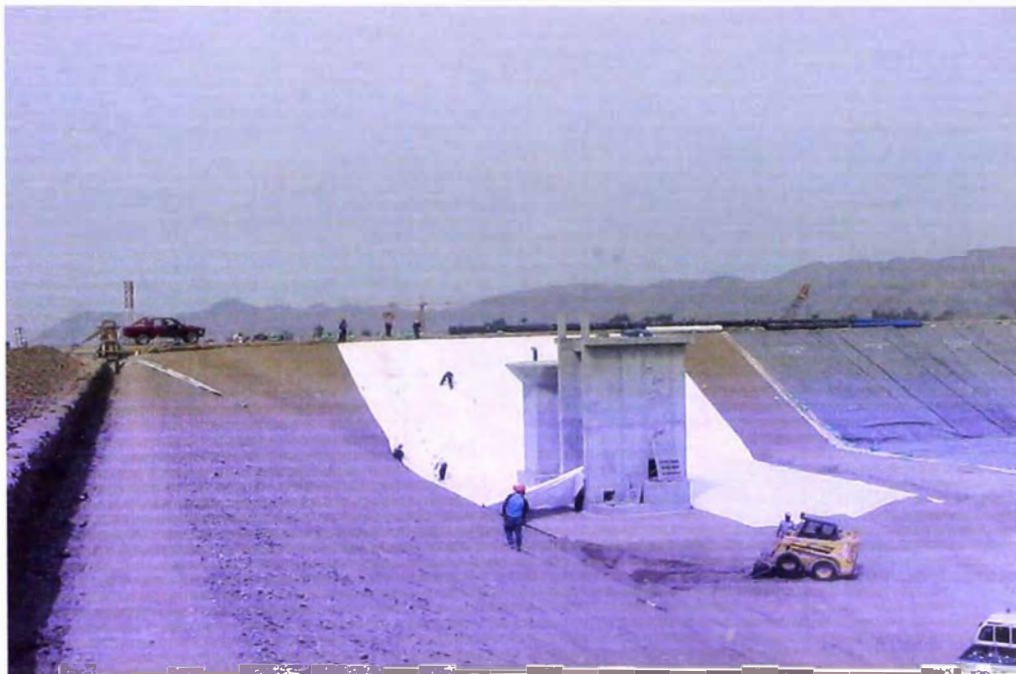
Estructura de salida, compuertas planas de accionamiento manual por su montaje.
